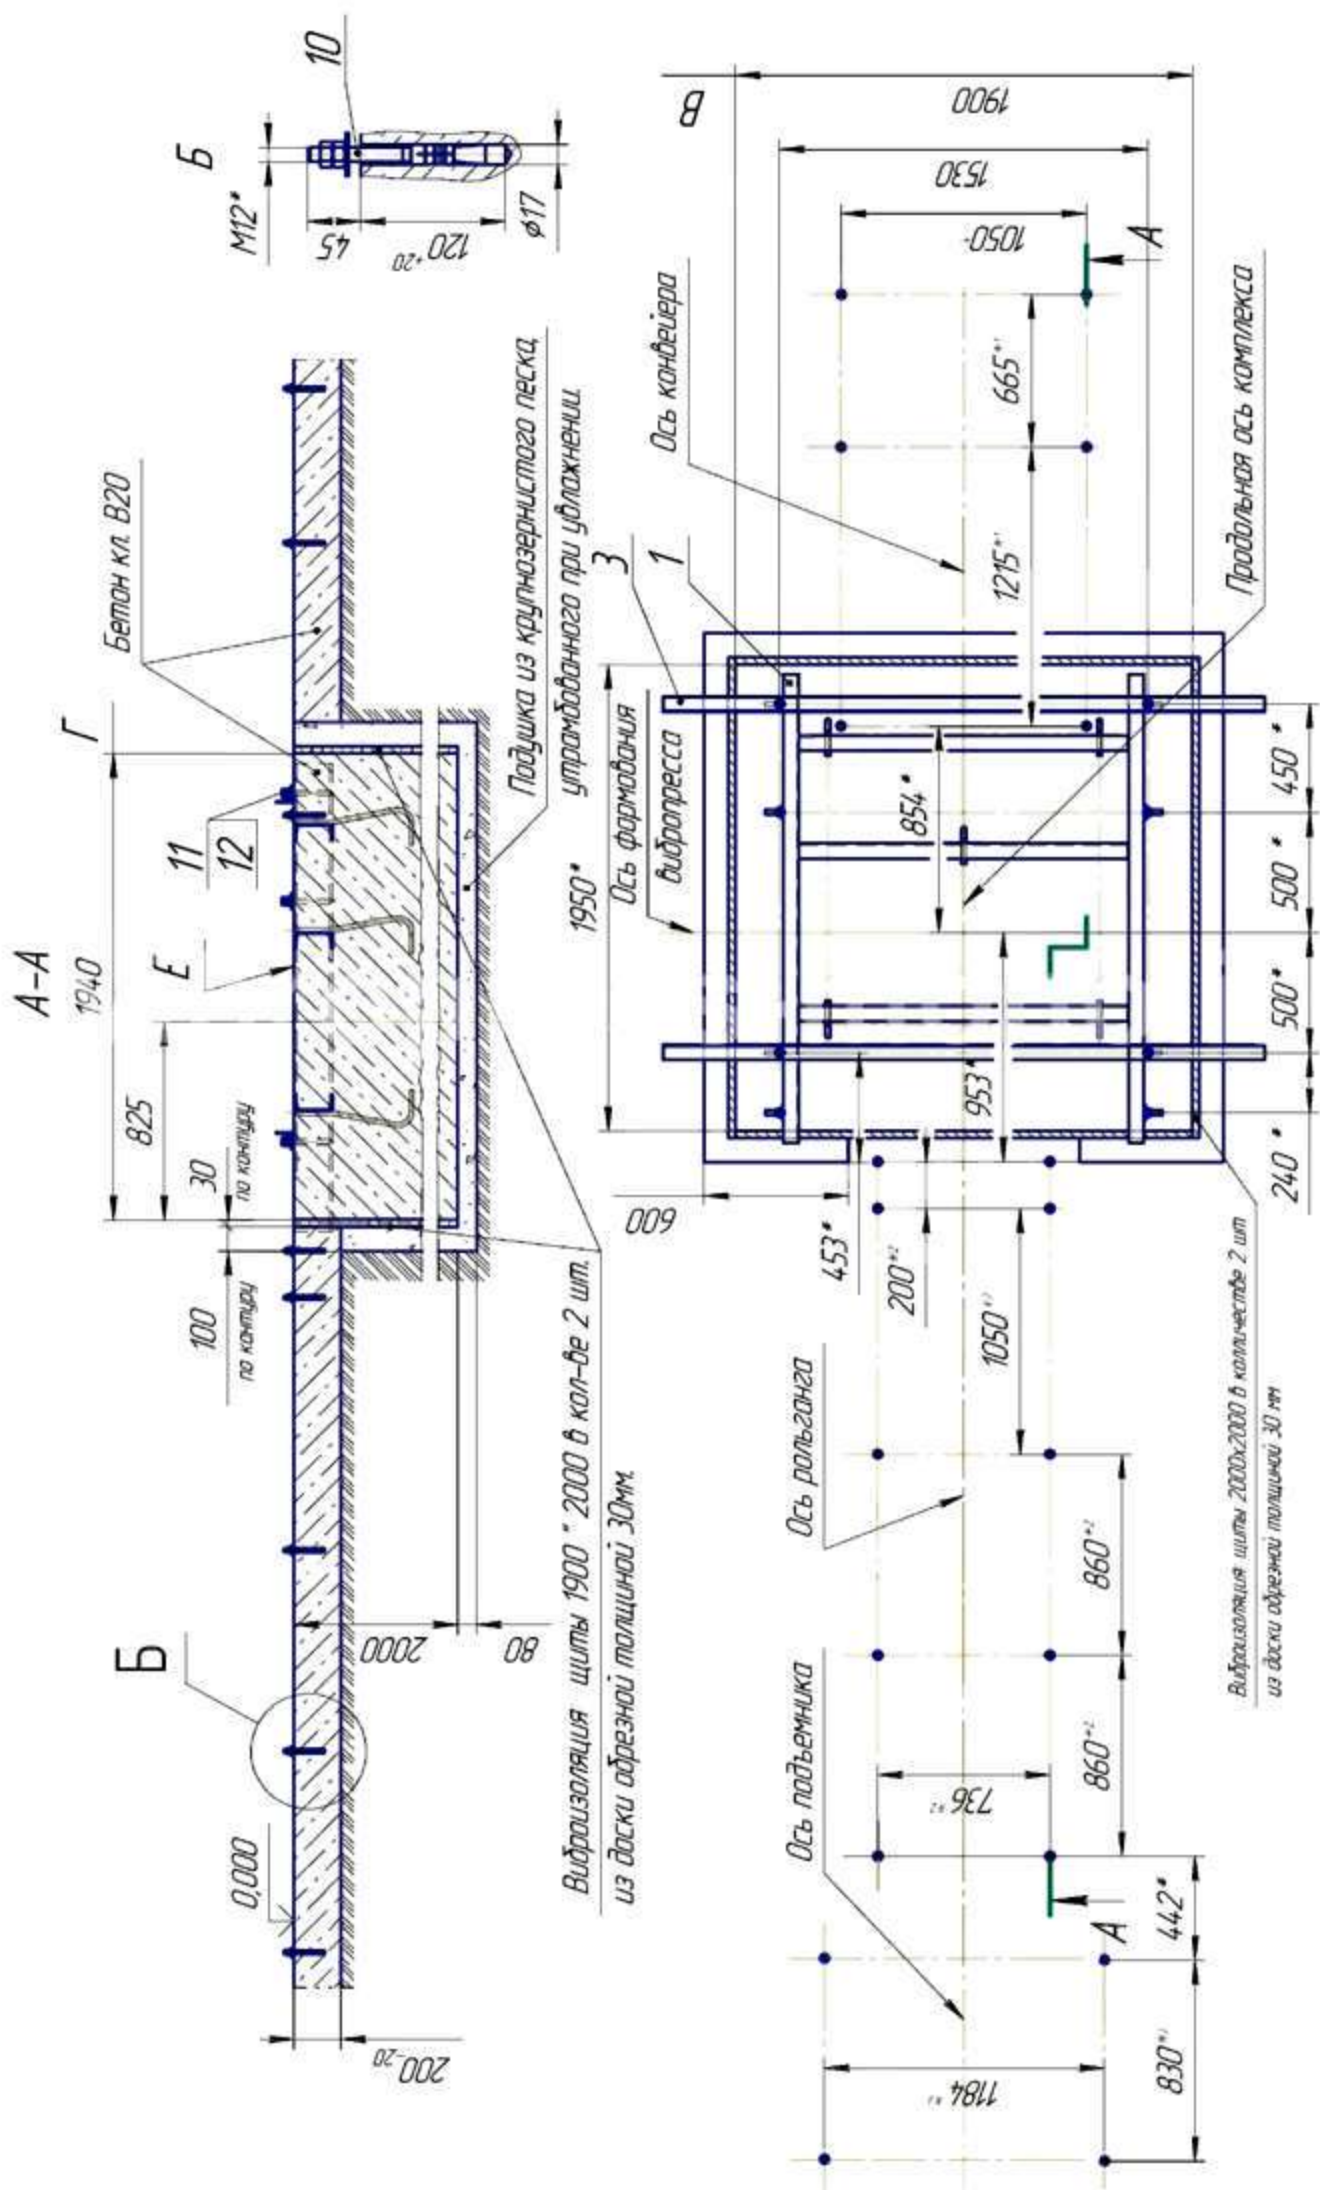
План фундамента комплексов Атлант и Атлант-Цвет
